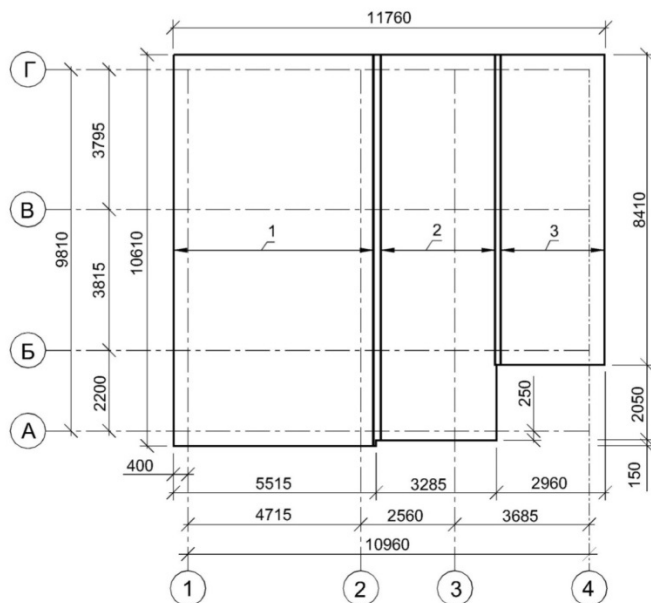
Армирование ППМ на отметке -0,130
